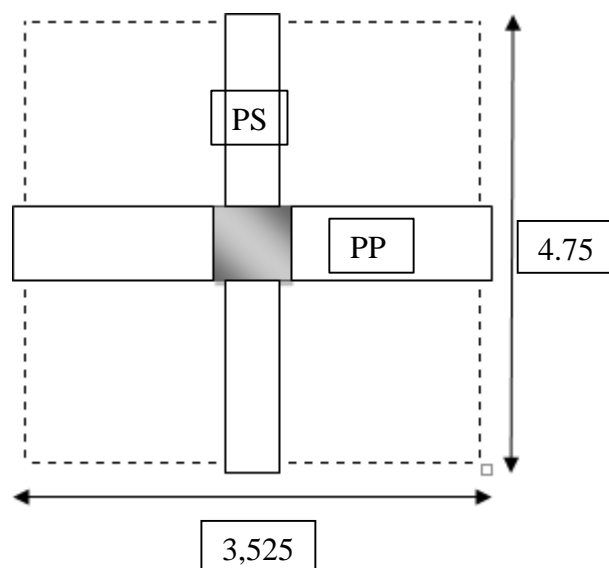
Section supporté par le Poteau le plus sollicité.
